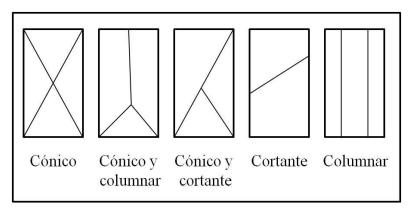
Planos de falla de cilindros de concreto ASTM C-39
